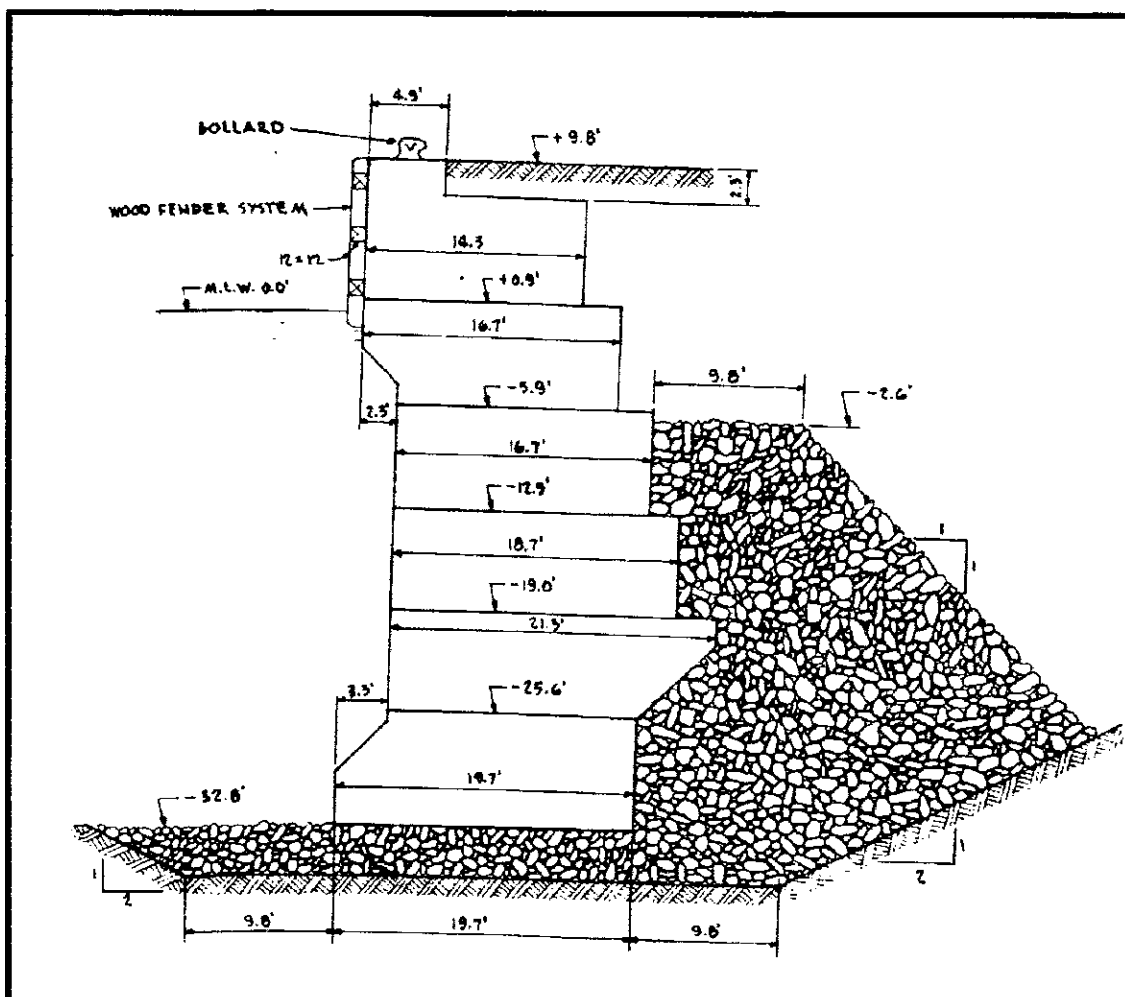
Muro de gravedad construido de bloques de concreto prefabricado
